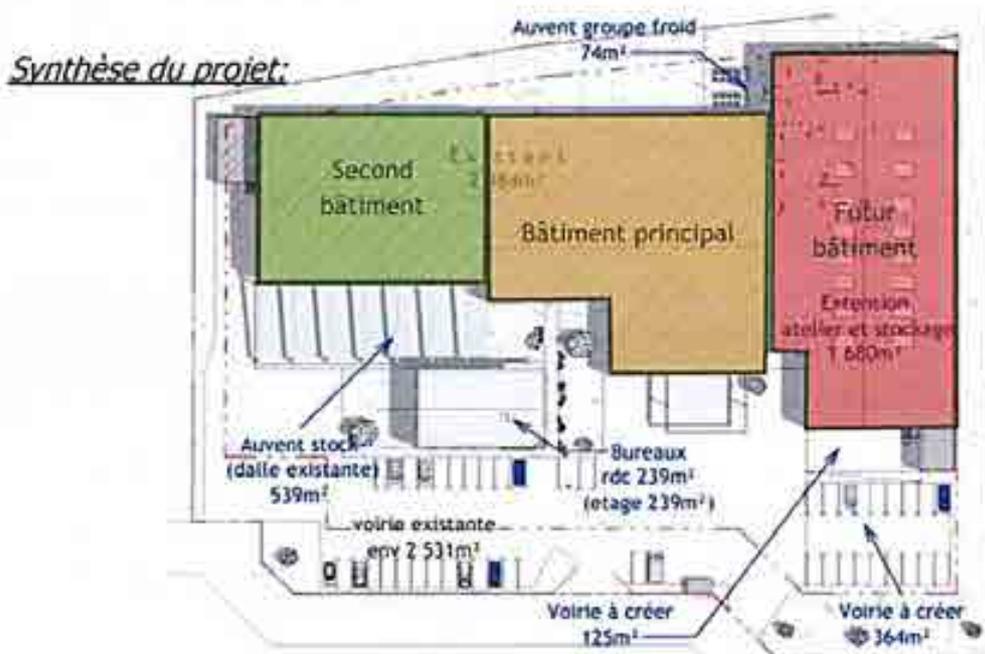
Extrait du permis de construire avec localisation des trois bâtiments
